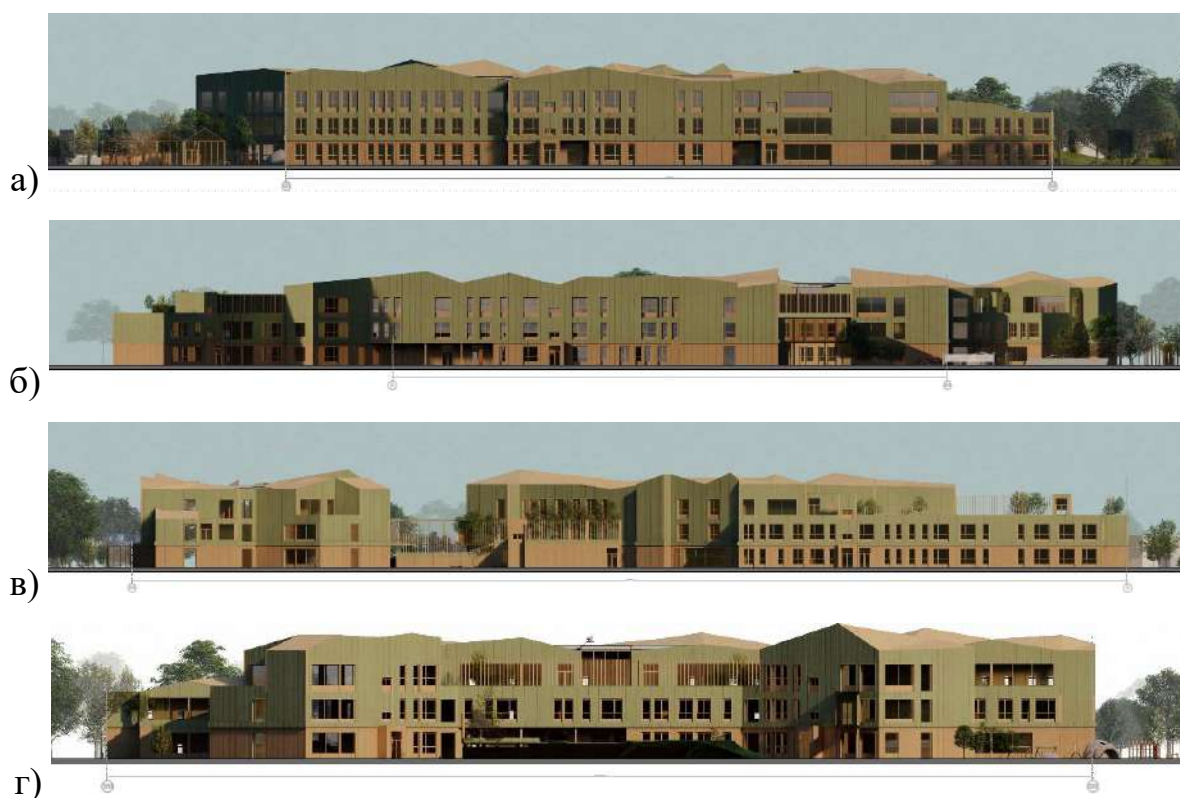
Фасади навчального центру: а) фасад в осяг АТ-БУ, б) фасад в осях К-АИ, в) фасад в осях 44-1, г) фасад в осях БУ-АТ..
